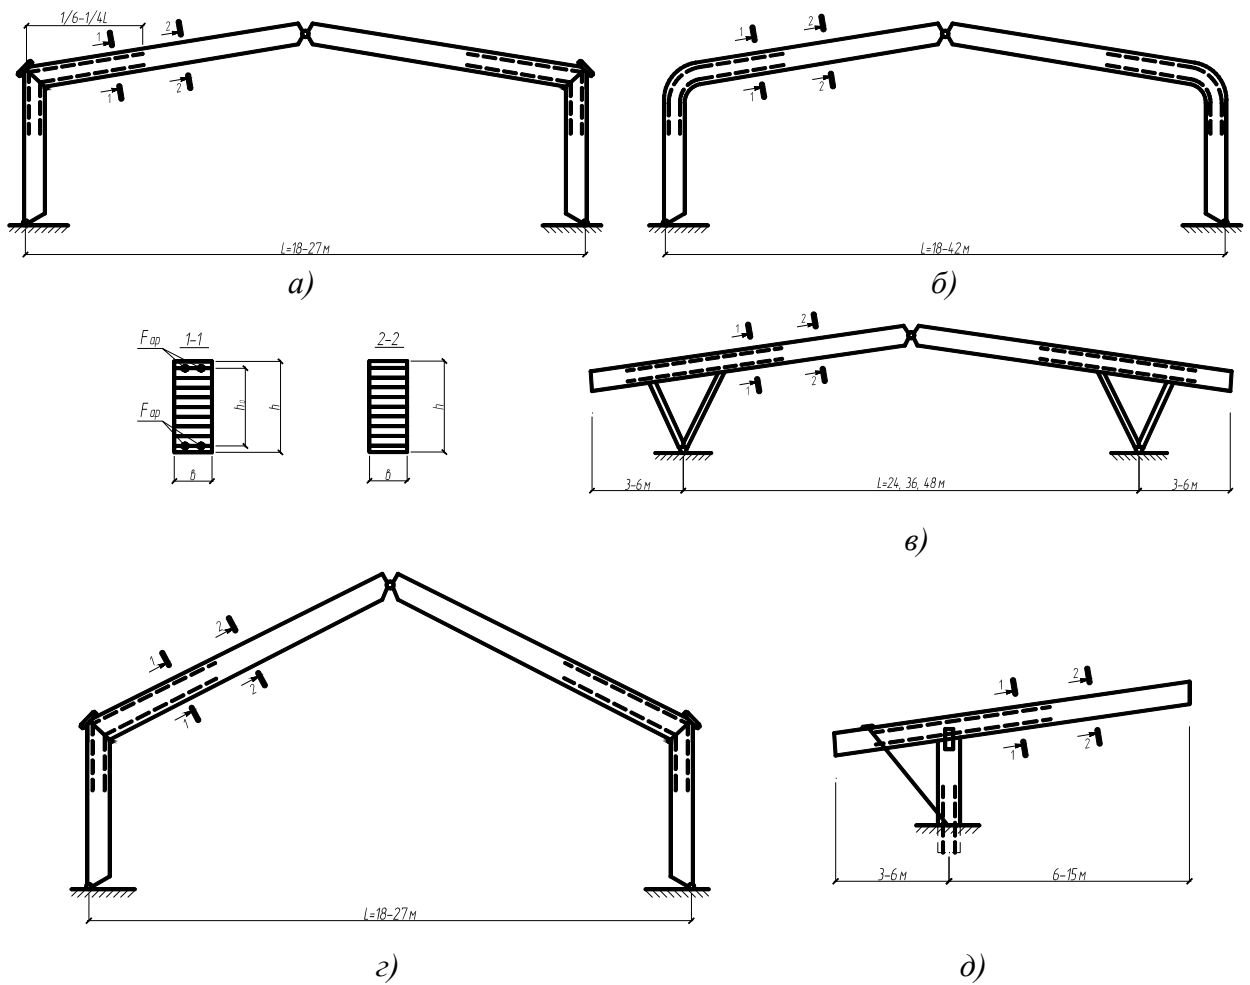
Клееные армированные деревянные рамы: а – из прямолинейных элементов; б – гнукотклееная; в – с V-образными стойками; г – стрельчатая; д – консольная
